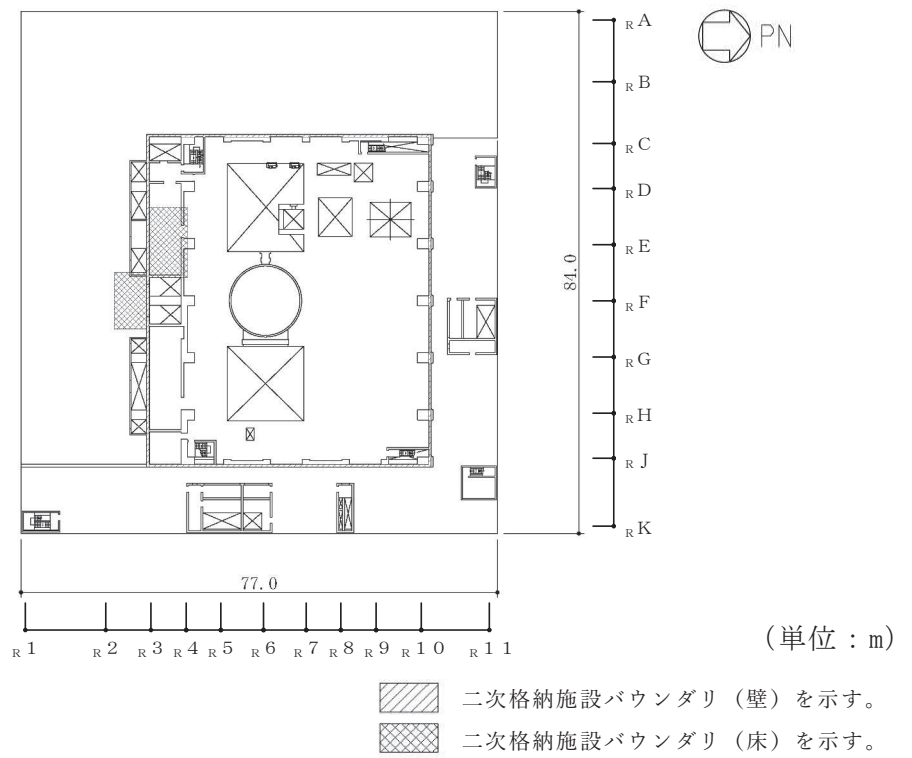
原子炉建屋原子炉棟（二次格納施設）の範囲の平面図
